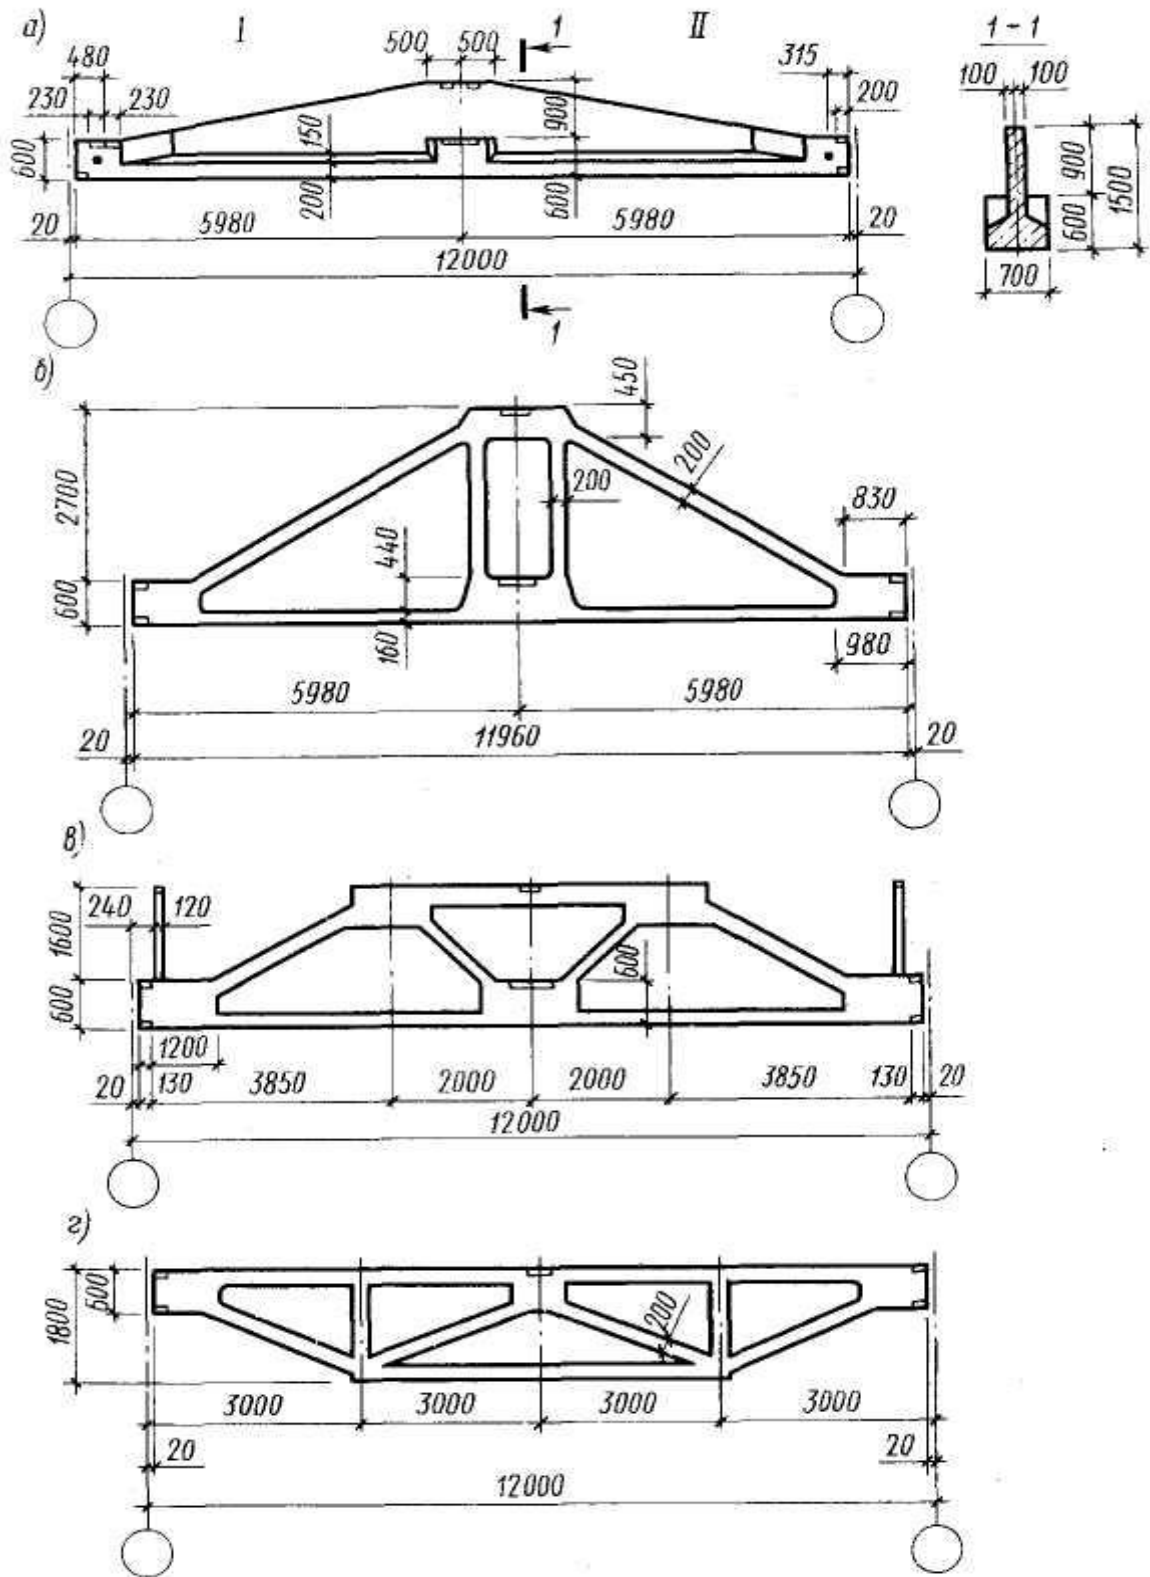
Железобетонные подстропильные балки и фермы [23]:
